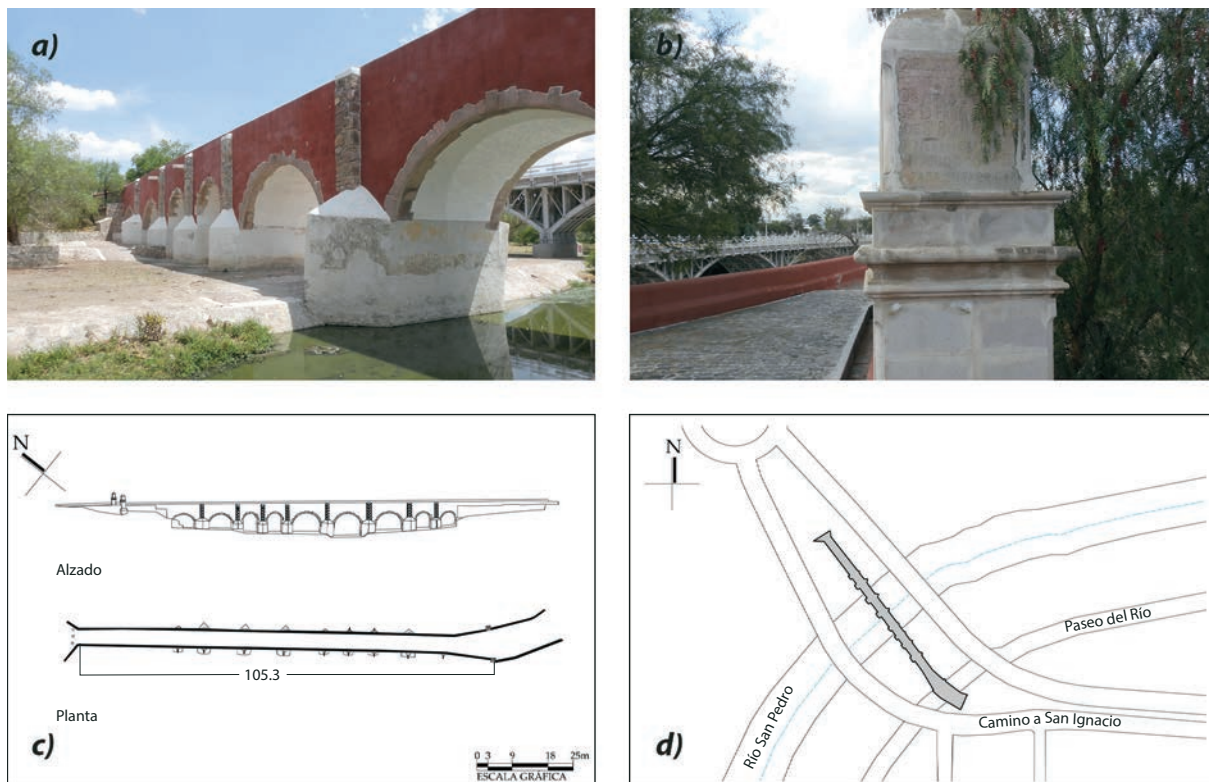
a) fachada poniente, b) detalle de cartela, c) croquis arquitectónico y d) croquis de localización del puente de San Ignacio.
